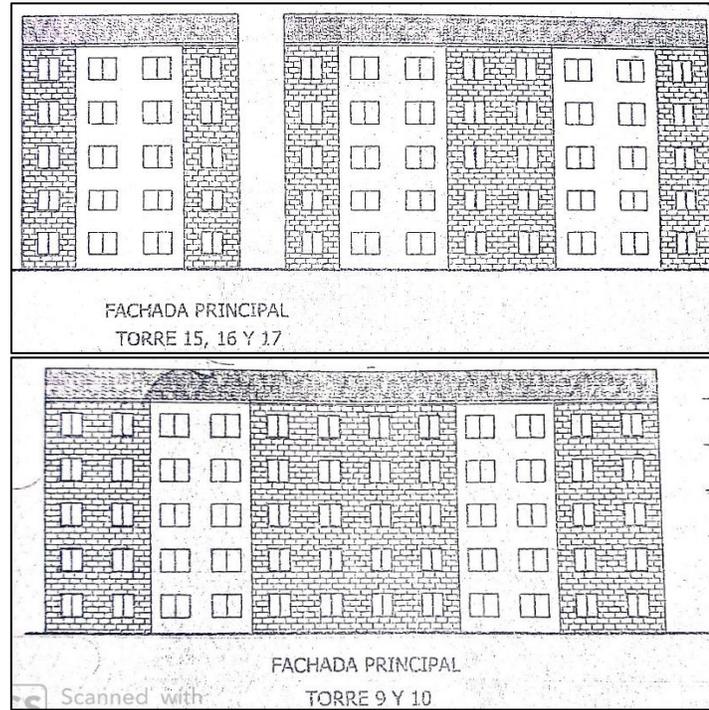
Segunda Etapa Vista Campestre - San Gil
